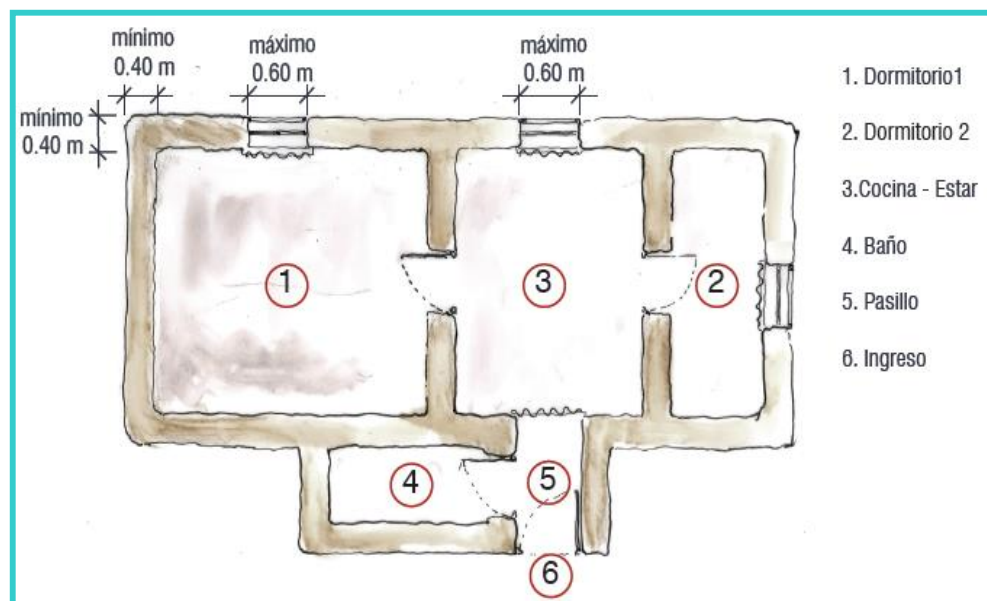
Planta de una Vivienda Típica de Espacios Libres
